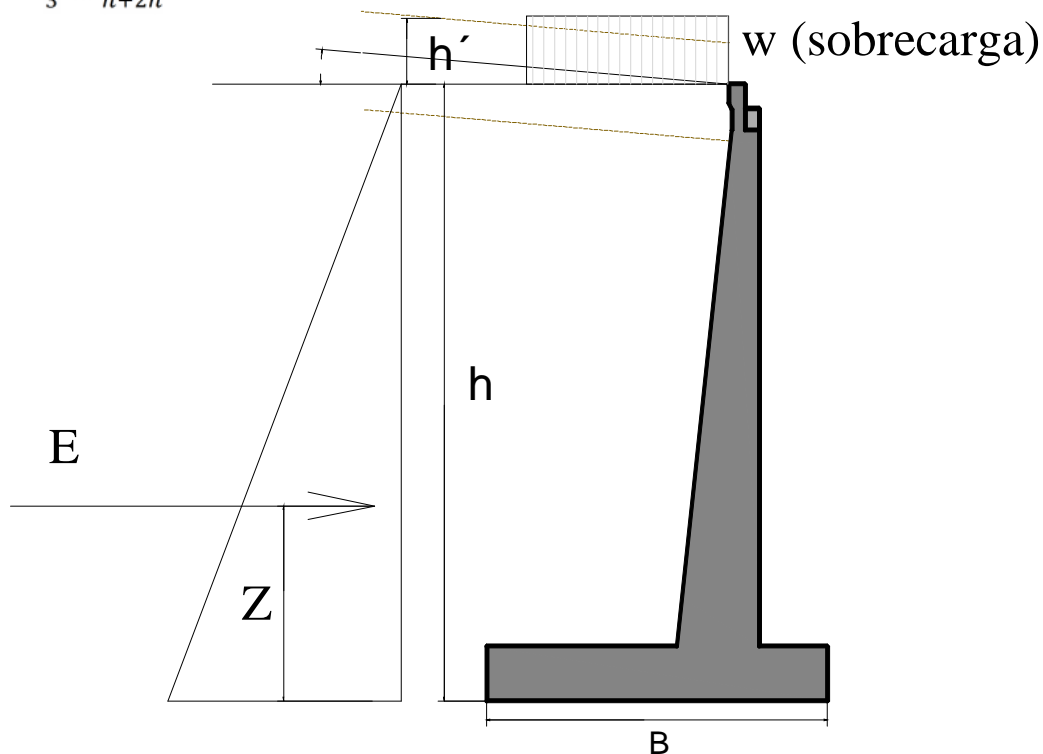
Corte transversal del puente: AUTOR Pedro Hurtado L.
